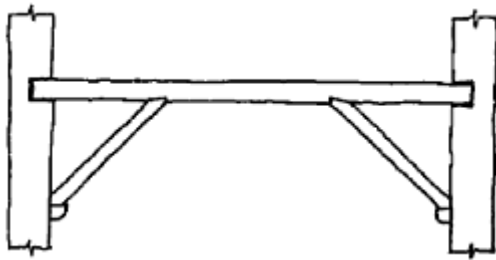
Disposición de jabalones mediante ensamble en viga.
